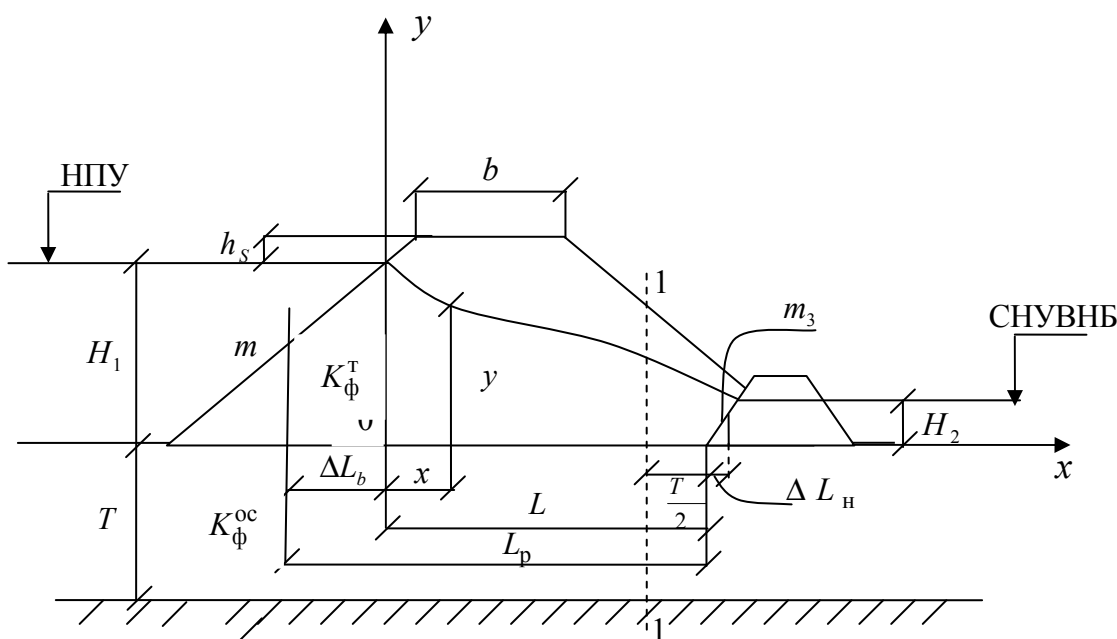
Схема к расчету через плотину с дренажной призмой
